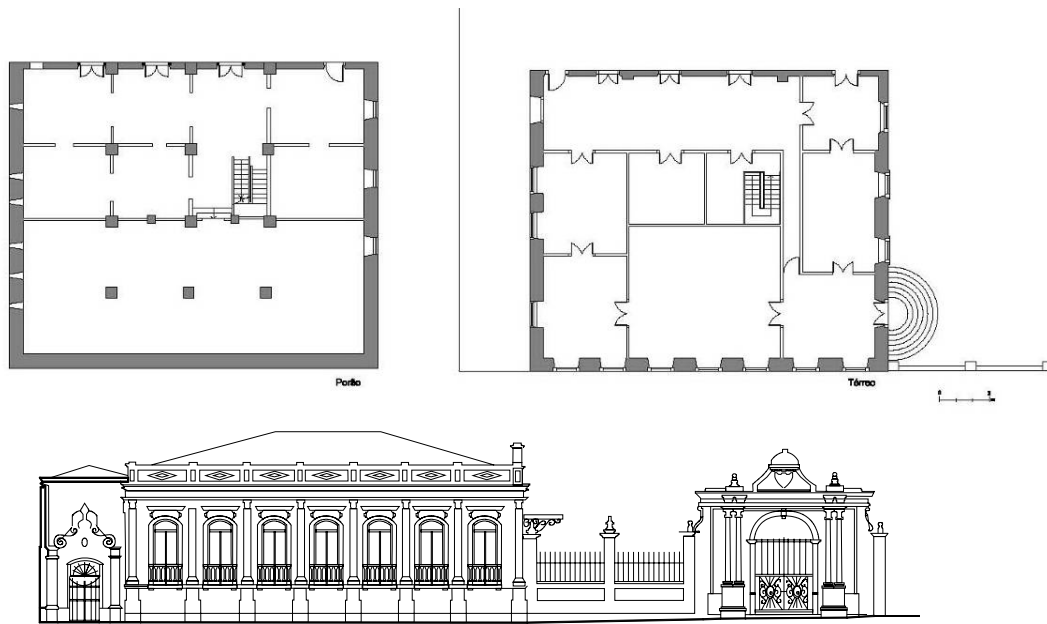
Solar dos Câmara, construído em 1818; ampliação e reforma da fachada de 1870. Plantas do corpo inicial e fachada.
